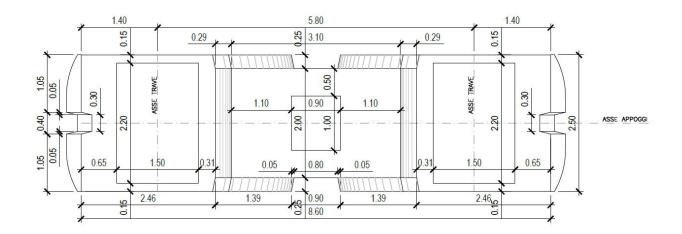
Sezione Tipica allo Spiccato Fondazione (P3).
